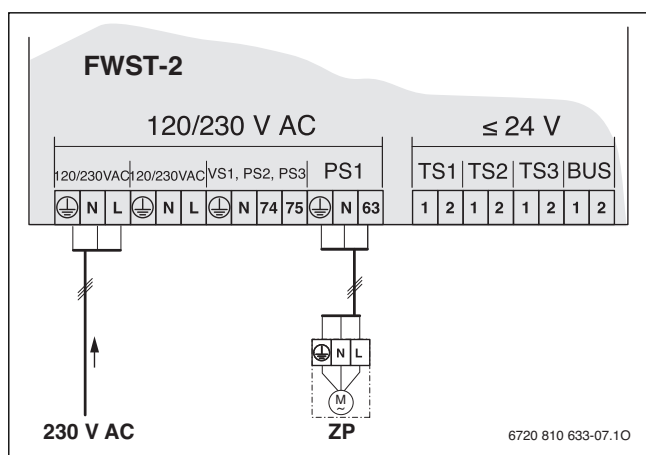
Anschlussplan CU FWST-2 (Legende → Bild 1)
